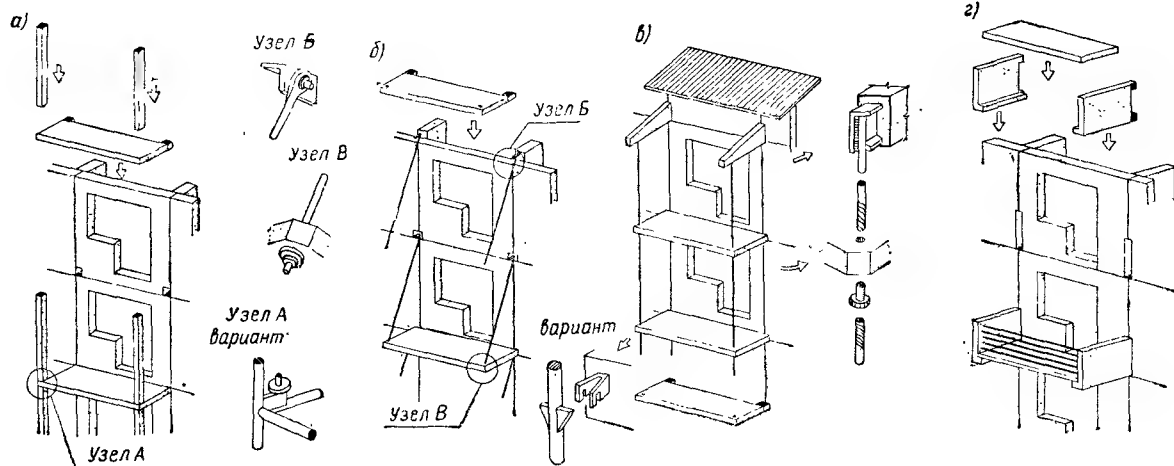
Конструктивные схемы балконов в домах с самонесущими и навесными стенами
